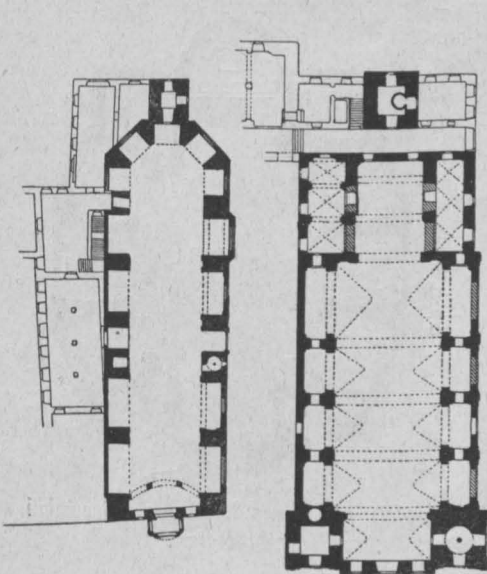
Grundriß der Franziskanerkirche, I. Bez.
